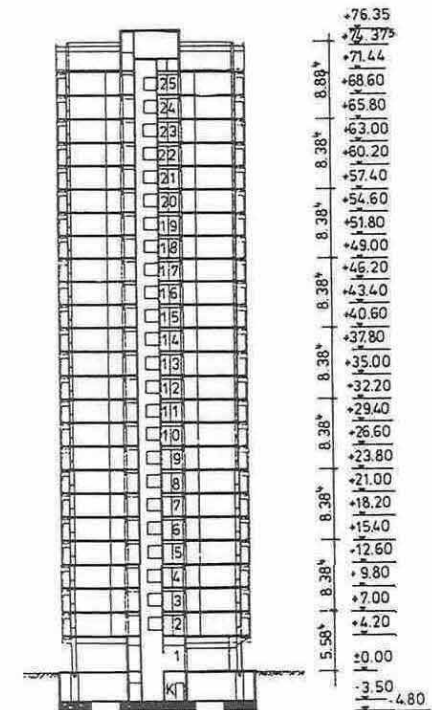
Querschnitt durch ein 25geschossiges Wohnhochhaus
